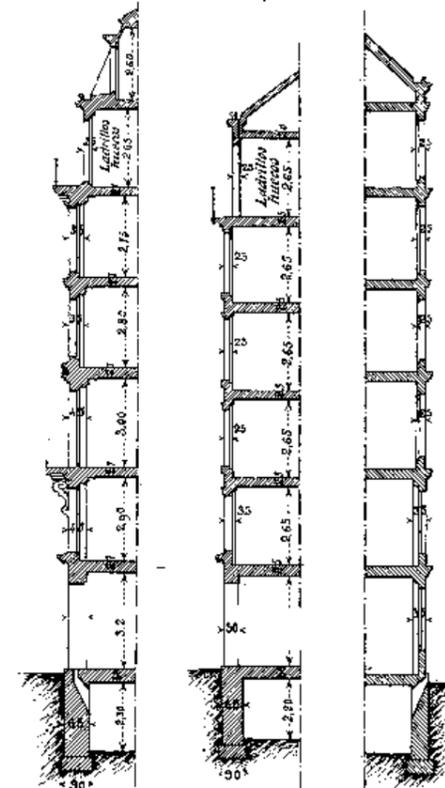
Ejemplos de la construcción de un muro de carga. Tratado práctico de edificación. E.Barberot
